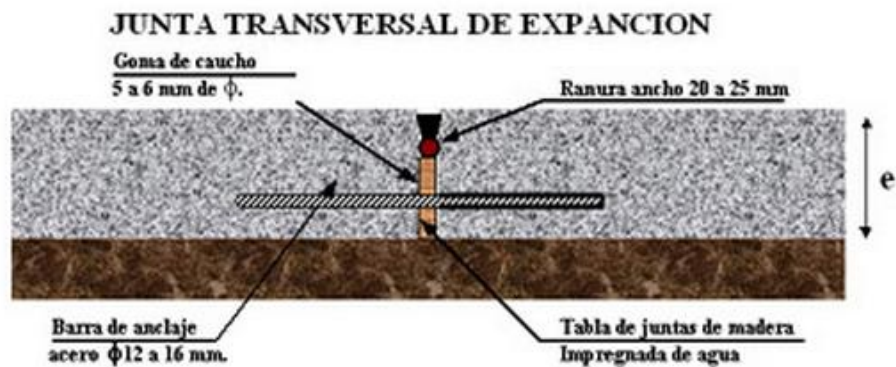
Junta de expansión empleada en pavimentos rígidos.
